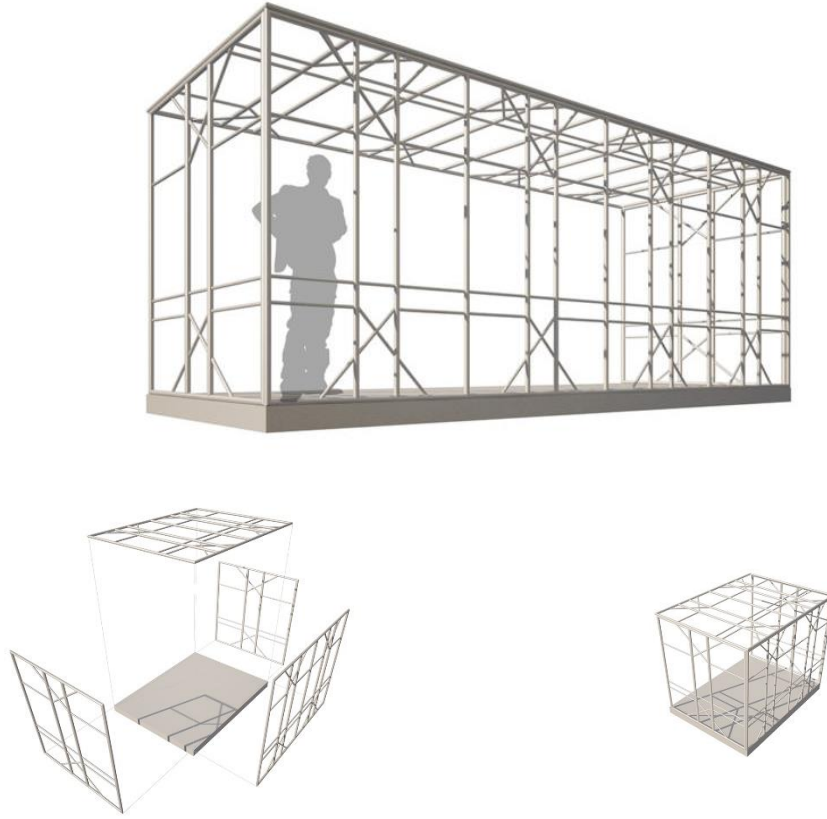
Prefab Parasite'a ait plan, kesit ve görünüşler (ArchDaily, 2009b)
